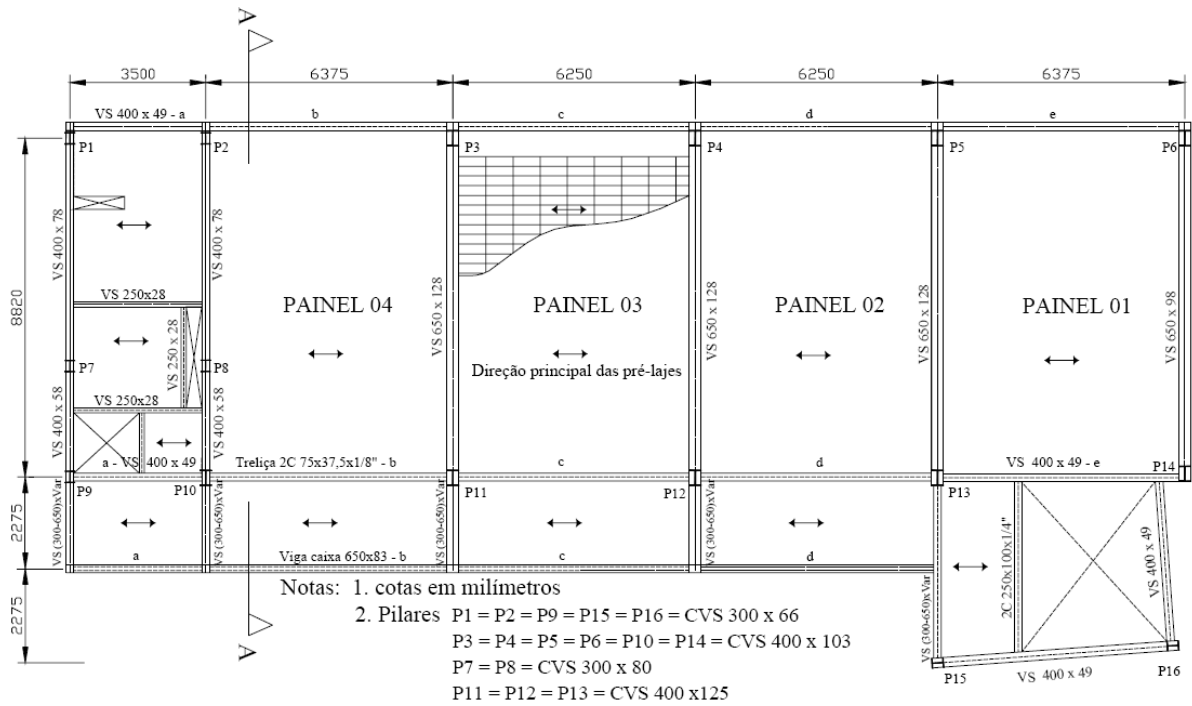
Estrutura do pavimento tipo do edifício (Battista e Varela, 2002).
